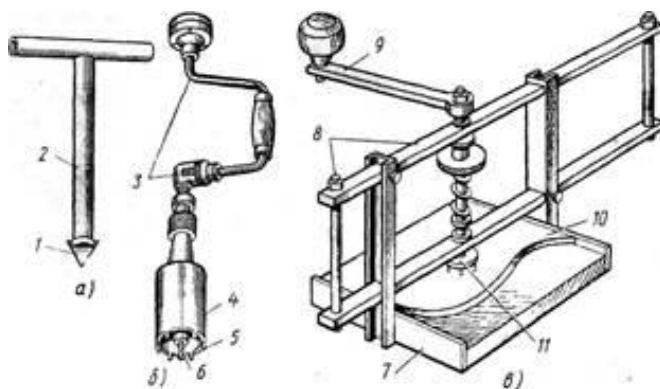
Інструменти і пристосування для свердлення отворів в керамічних плитках: а – розгортка, б – коловорот з приставкою, в – пристосування для свердлення; 1 – наконечник з твердого сплаву, 2 – корпус з ручкою, 3 – коловорот, 4 – приставка 5 – різці з твердого сплаву, 6 – центральне свердло, 7 – підстава, 8 – рама, 9 – ручка різця, 10 – плитка, 11 – різець
